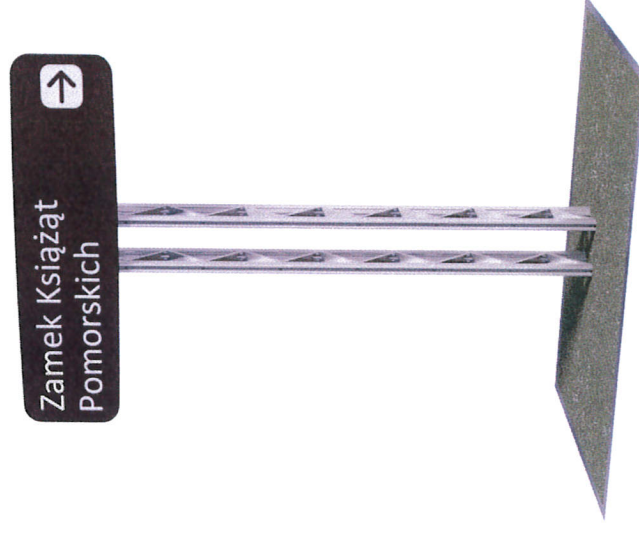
Fundamenty i konstrukcje wsporcze 3/4
